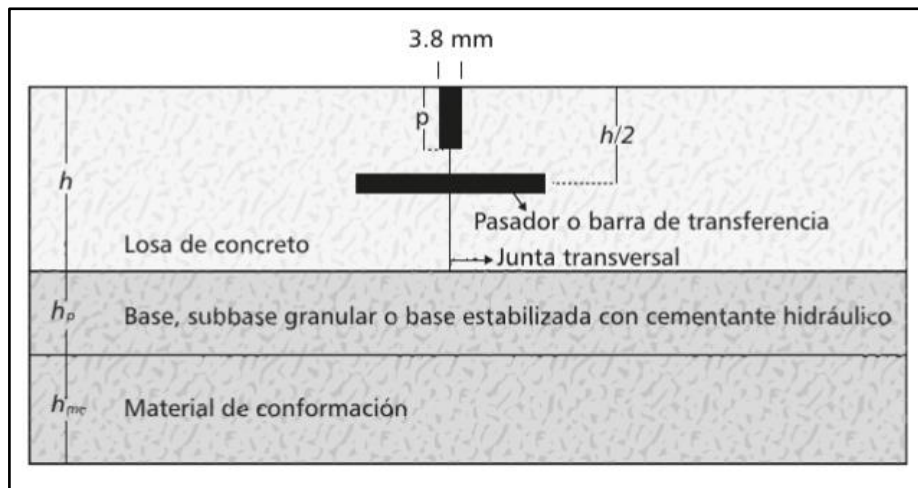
Perfil típico de la estructura de un pavimento rígido.
